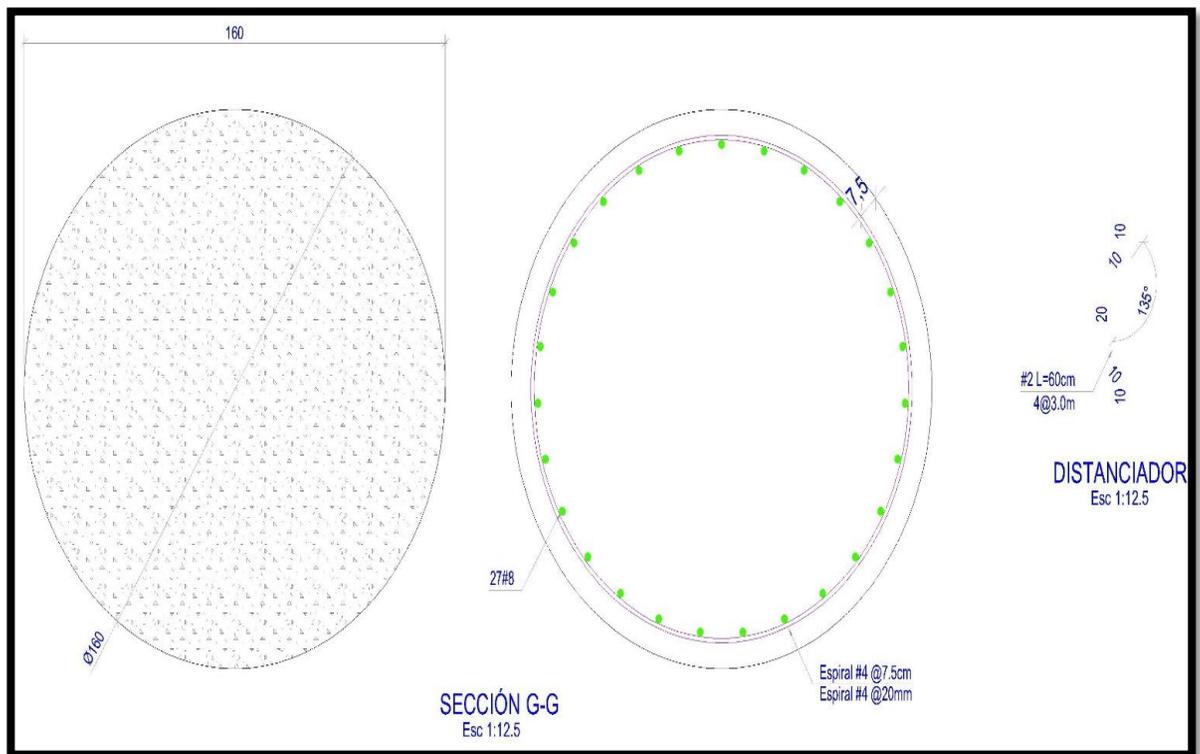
Detalle, despiece PL4. (Fuente: Diseño estructural MEISA)
